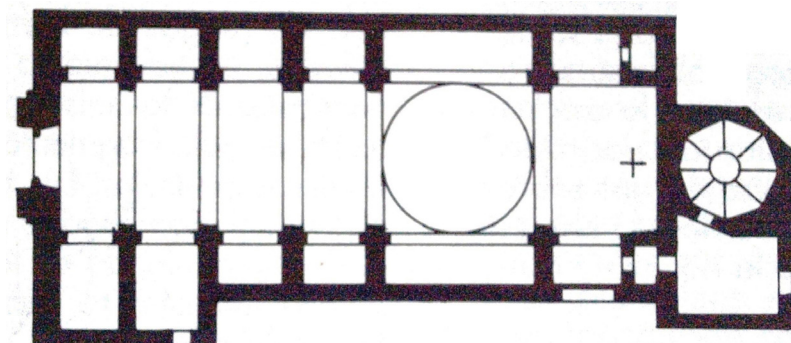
Planta de la iglesia del monasterio de Clarisas de Alicante. Autor: M. Bevià.
